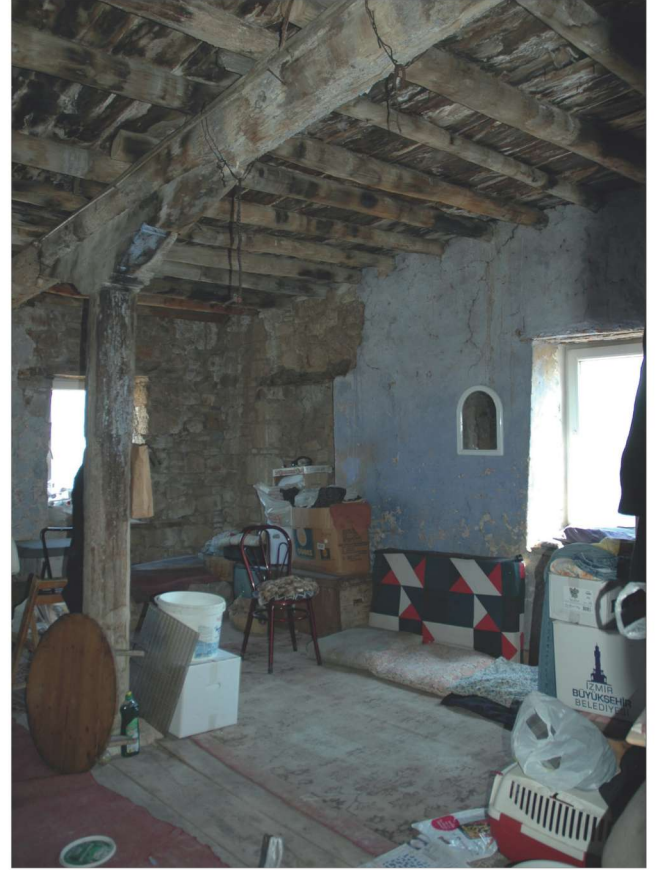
827 parsel, iç mekan. / Building lot: 827, interior
